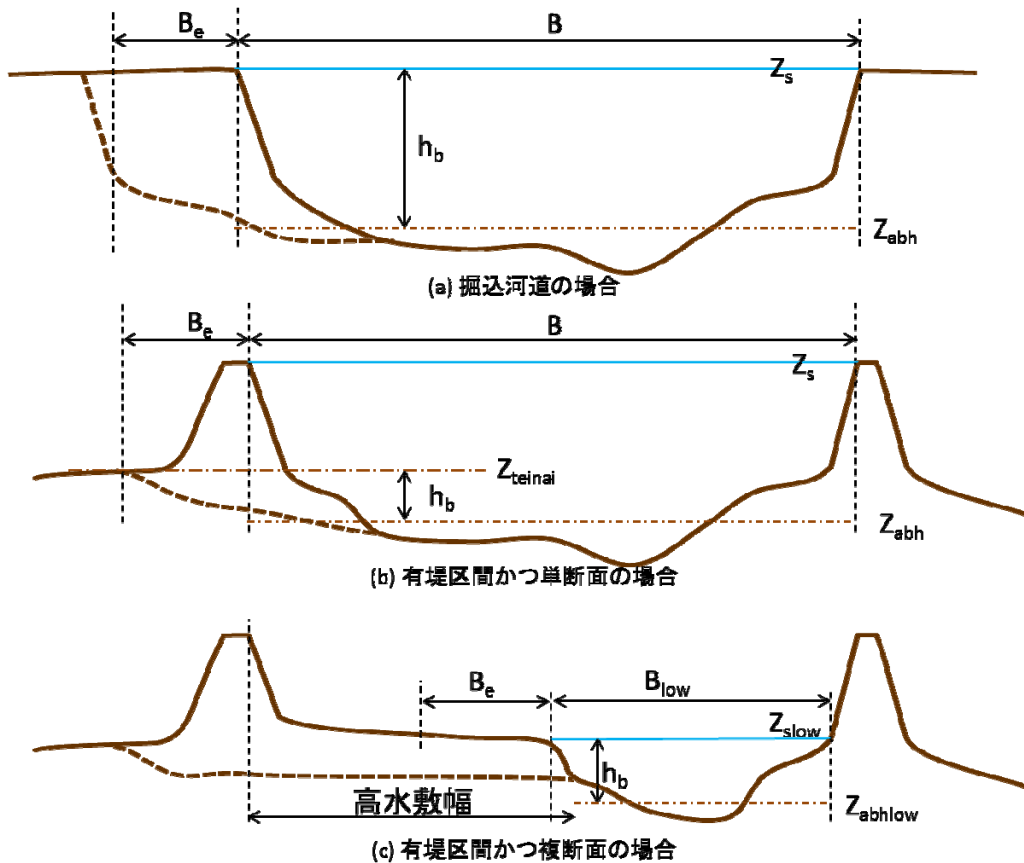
横断面図から読み取る川幅 B 、河岸高 h_b 、平均河床高 Z_{abh}
